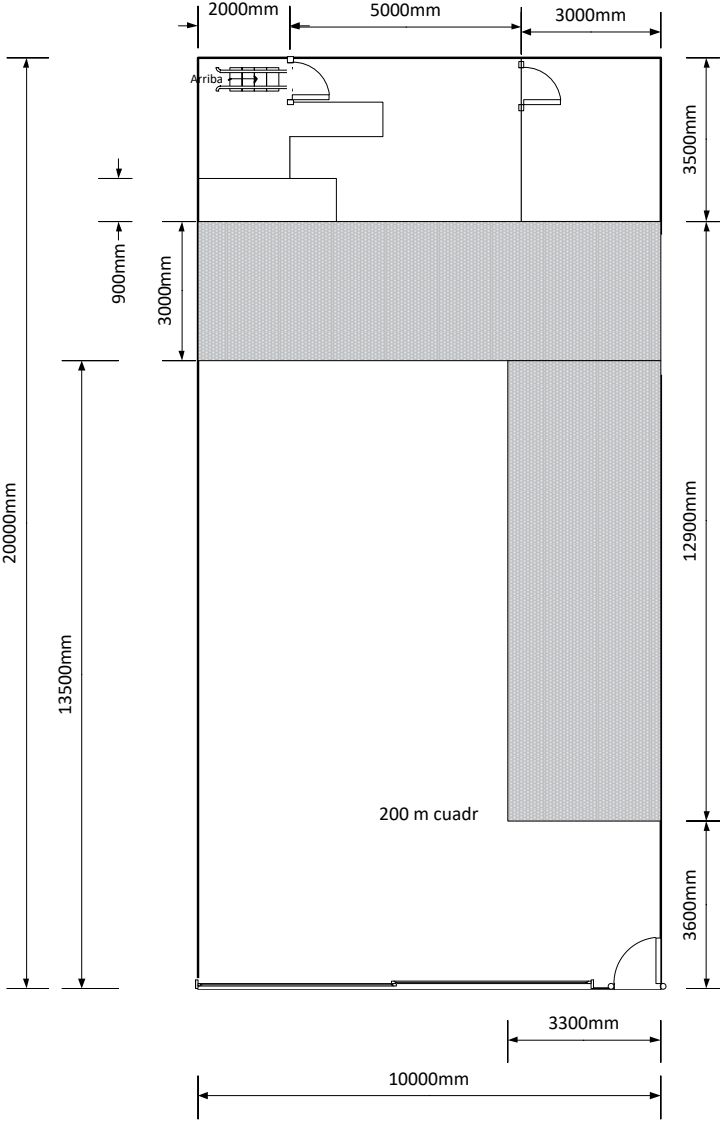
Layout de la nueva planta de manufactura objeto de estudio, planta alta
